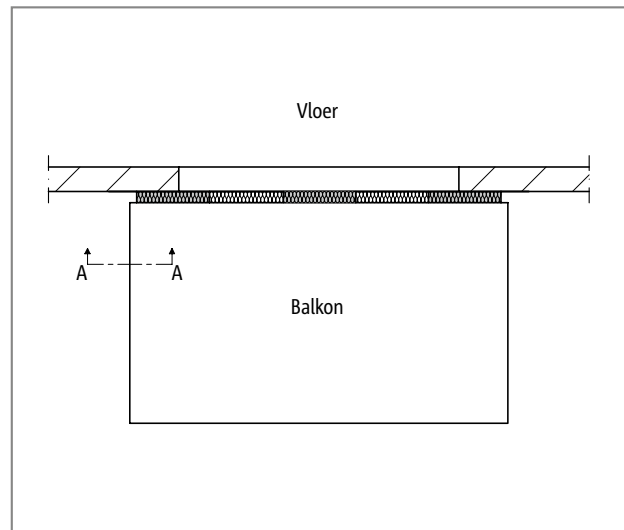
Schöck Isokorb® T type K-M12: Bijlegwapening bij directe ondersteuning
